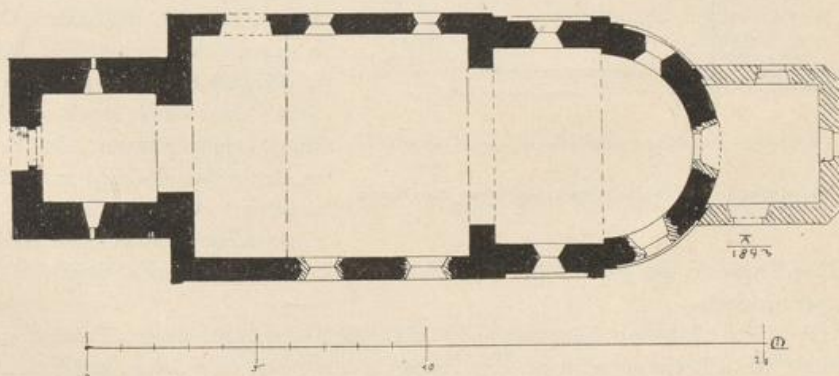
Refrath. Grundriss der alten katholischen Pfarrkirche.
